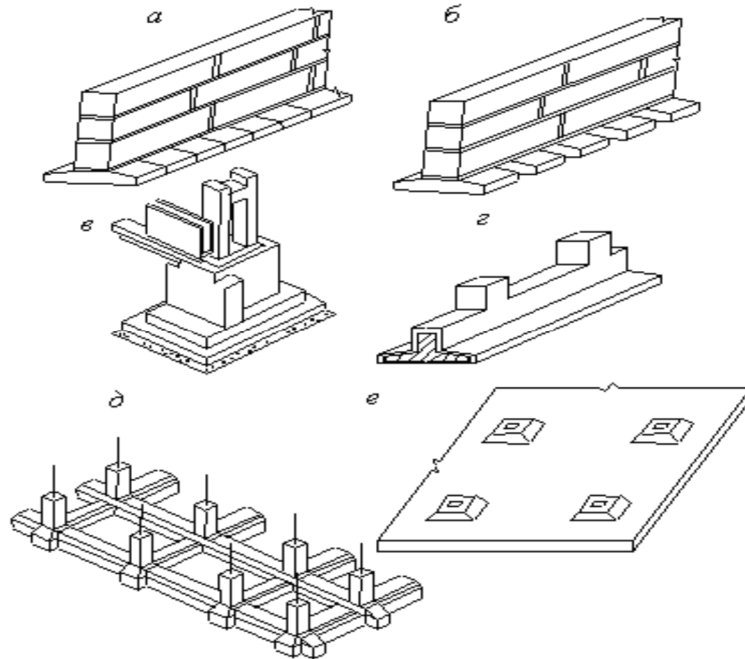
Типи фундаментів мілкого закладання: а – стрічковий під стіни, безперервний; б – стрічковий під стіни переривчастий; в – окремо стоячий під колону; г – стрічковий під колони; д – із перехресних стрічок; е – плитний
